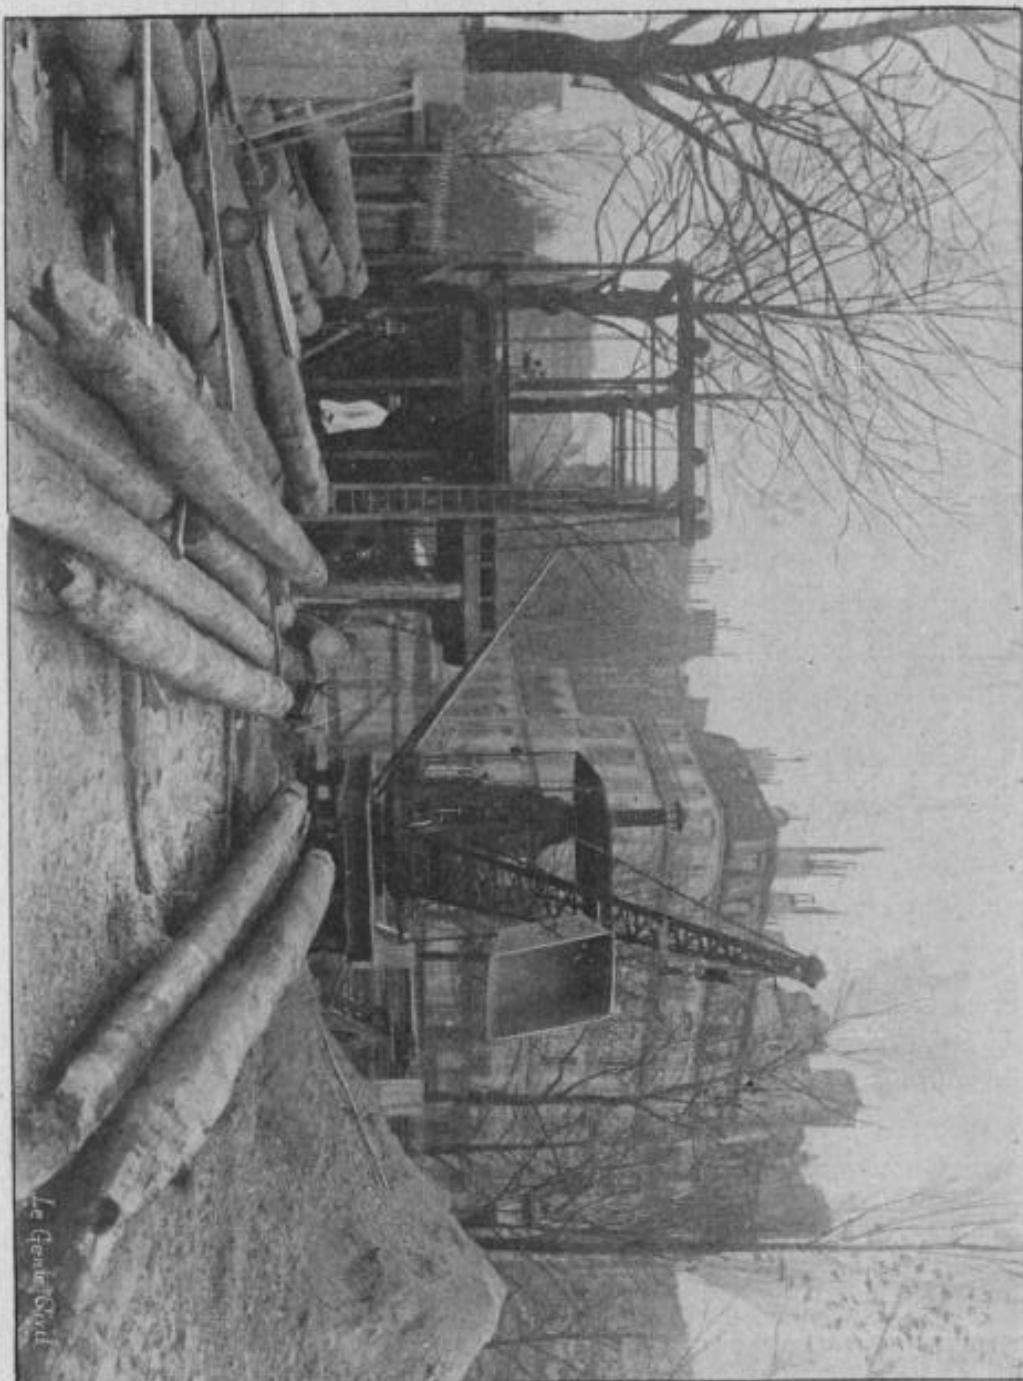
Construction de la ligne B : Chantier de la place des Ternes (vue prise le 2 mars 1901).
